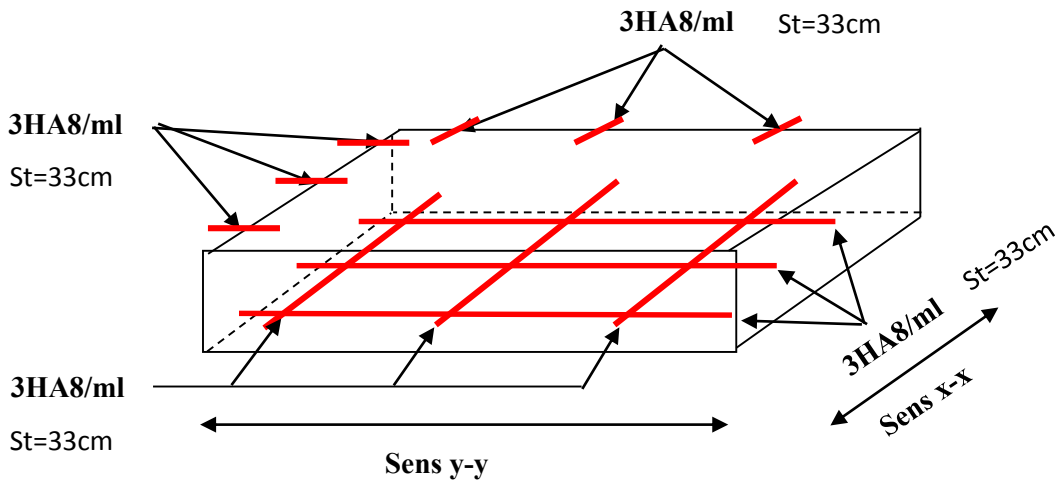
Schéma de ferrailage de la dalle pleine sous l'ascenseur
